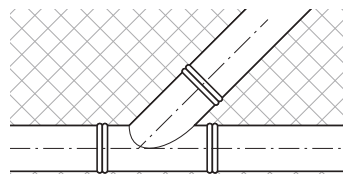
Pevný bod u zabetonovaných, izolovaných přímých průstupů stropem
